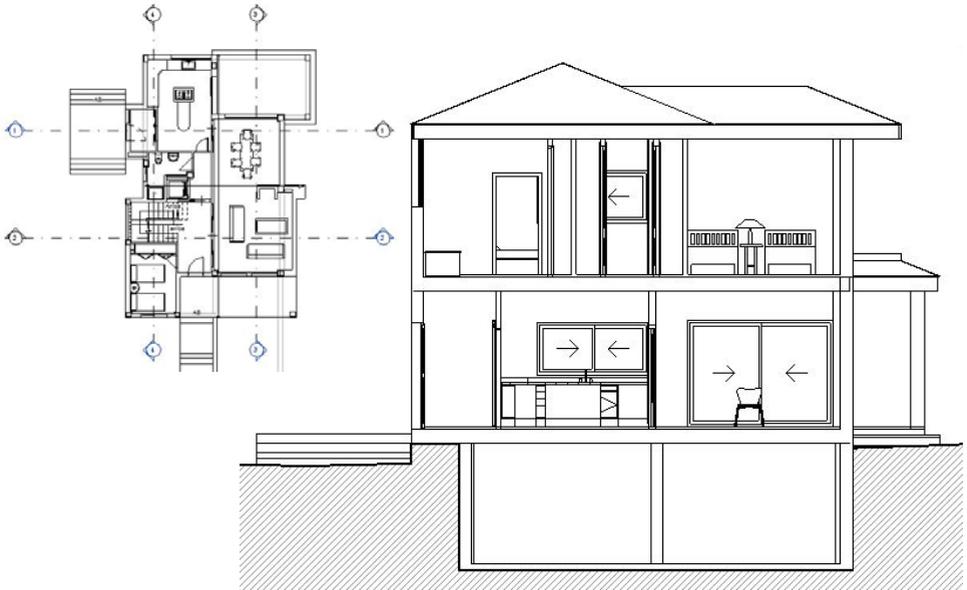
Sección 1 - 1' . Fuente propia Revit
